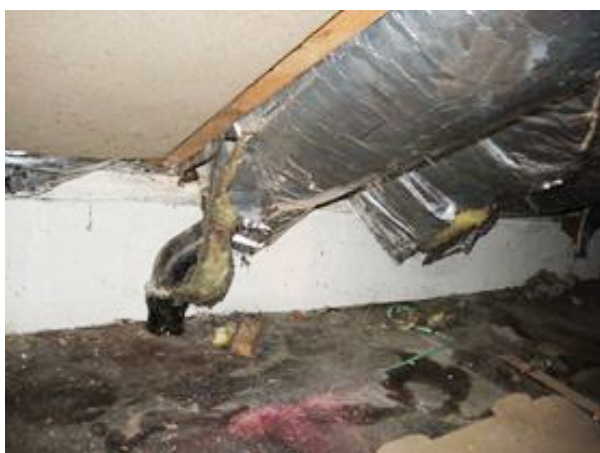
alte künstliche Mineralfaserdämmstoffe im Dachausbau
